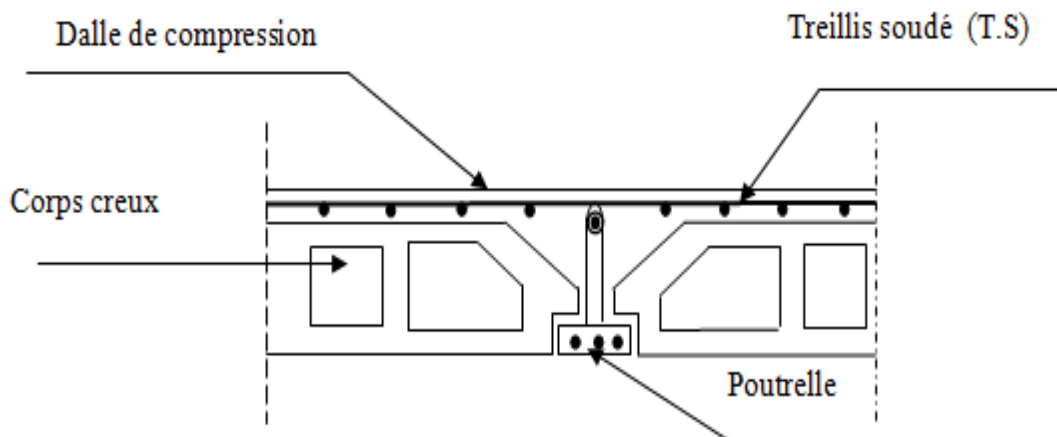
coupe transversale dans un plancher en corps creux
